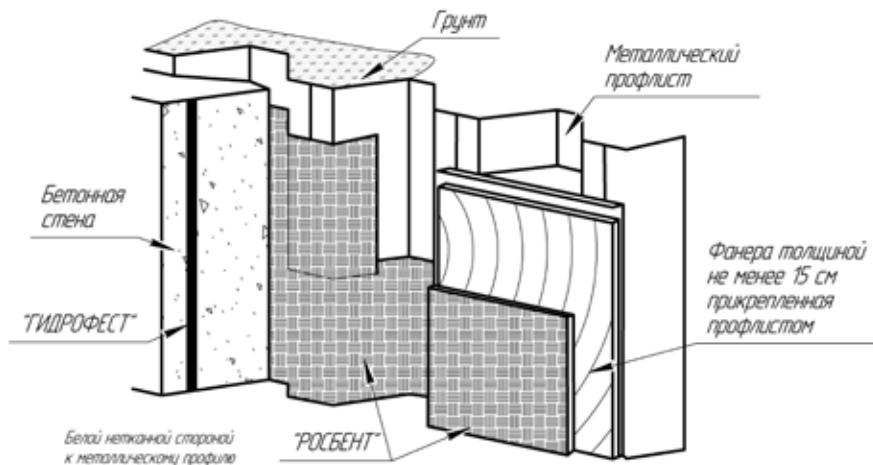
Вариант укладки «Росбент» на стену из металлического профлиста
